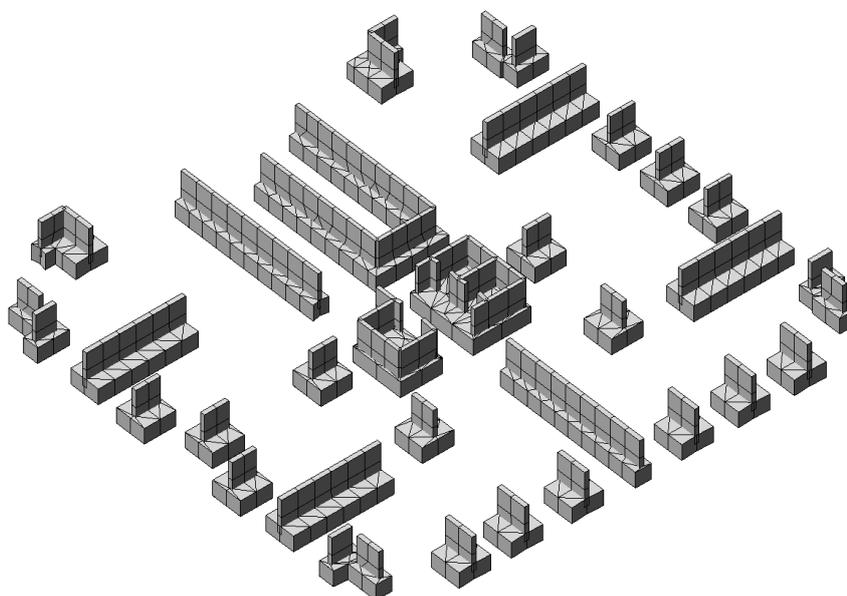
Общий вид фундамента под жилое 18-ти этажное здание.
